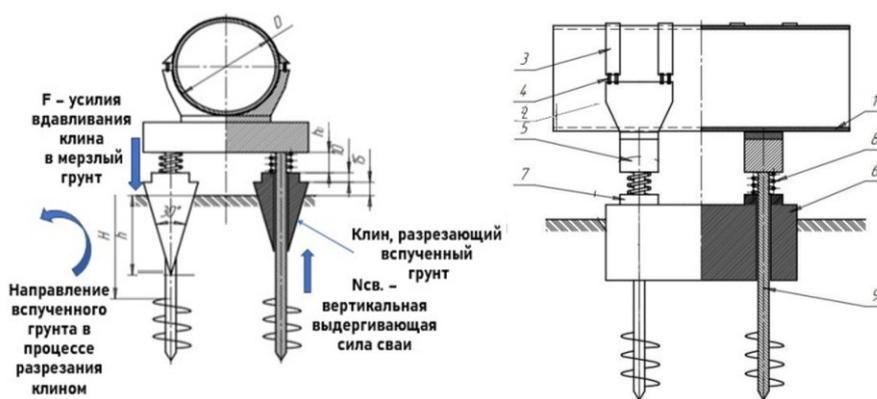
Разработанная опорная конструкция надземного трубопровода:
